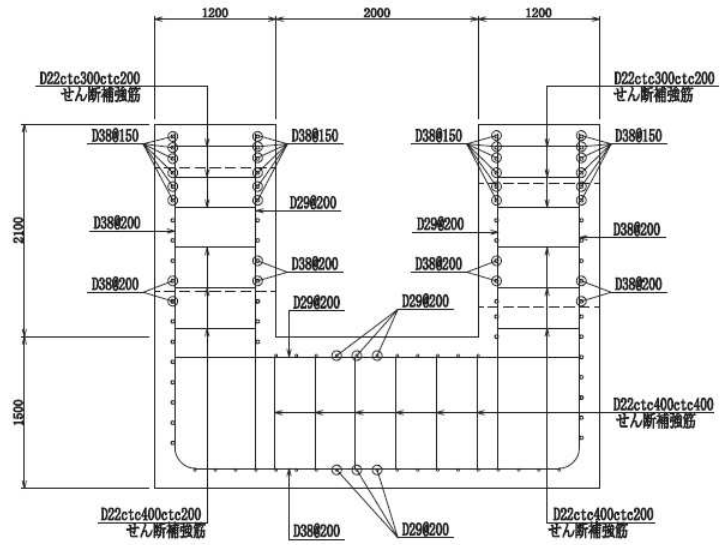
出口側集水ピットの配筋概要図 (単位: mm)
